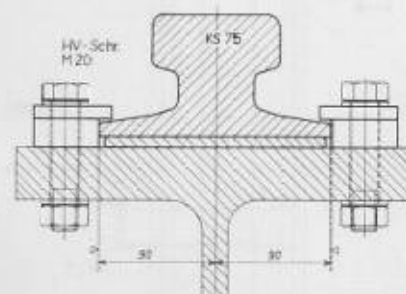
Kranschienebefestigung, neue Schmiede Sulzer, 1:6
